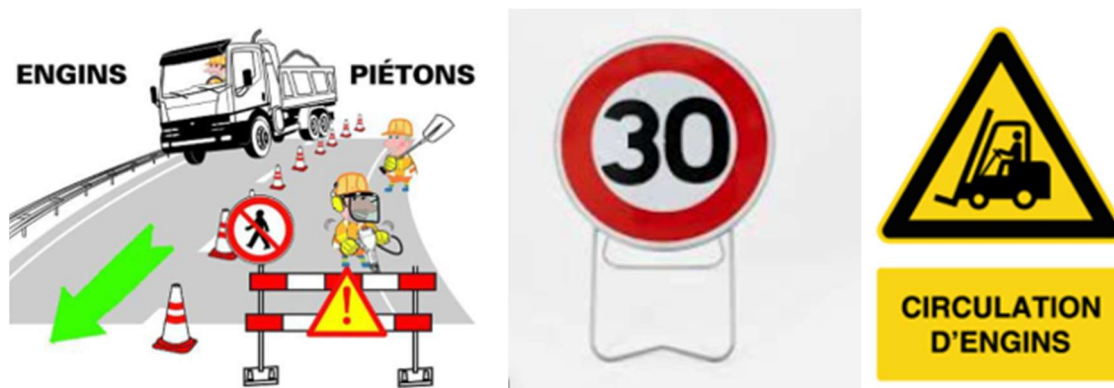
Exemples de plans de circulation de chantier (Bélon LA POINTE, 2019)
